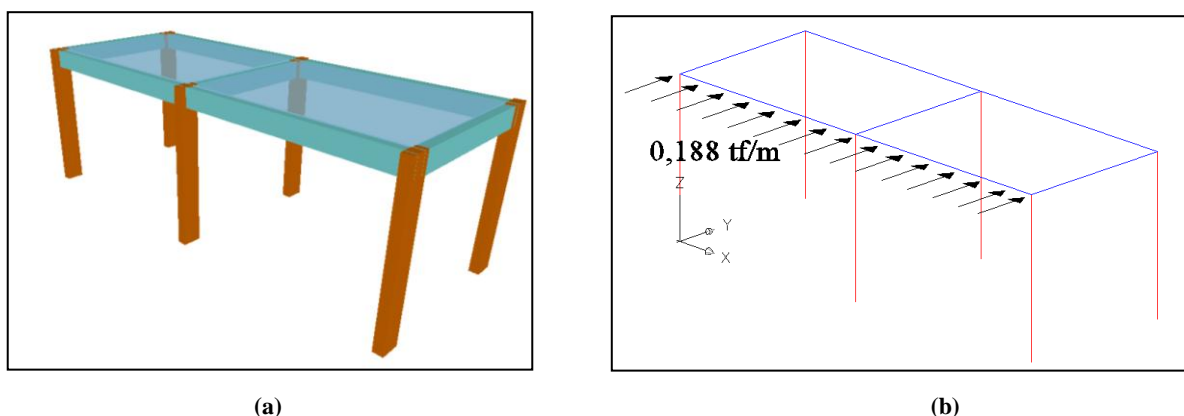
20 - Estrutura composta de pavimento rígido e pórticos com vigas e pilares: (a) Esquema em perspectiva volumétrica; (b) Esquema estrutural em barras.
